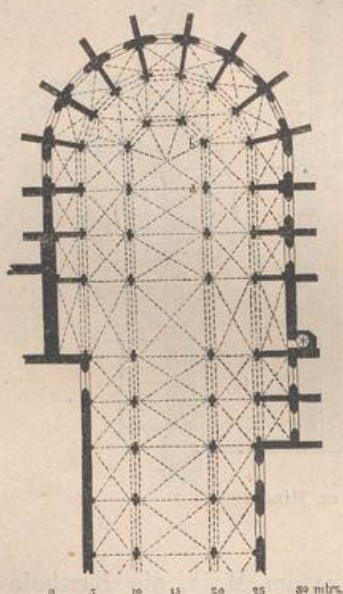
Kirche zu Zwettl. Grundriss.
